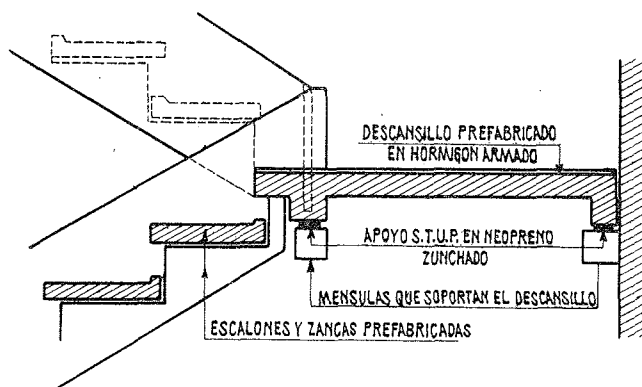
Apoyos de los descansillos, prefabricados, en hormigón armado.
